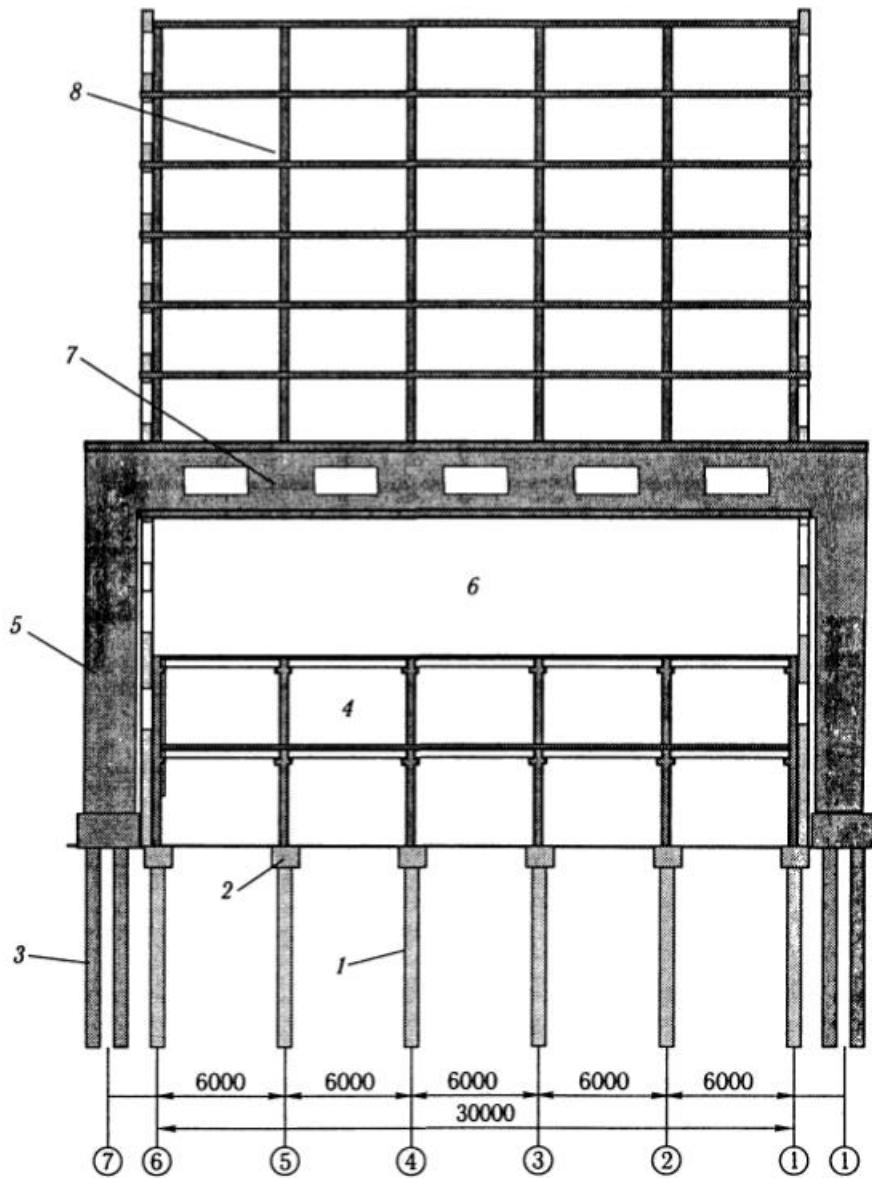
Надбудова багатоповерхової частини з переобиранням:
